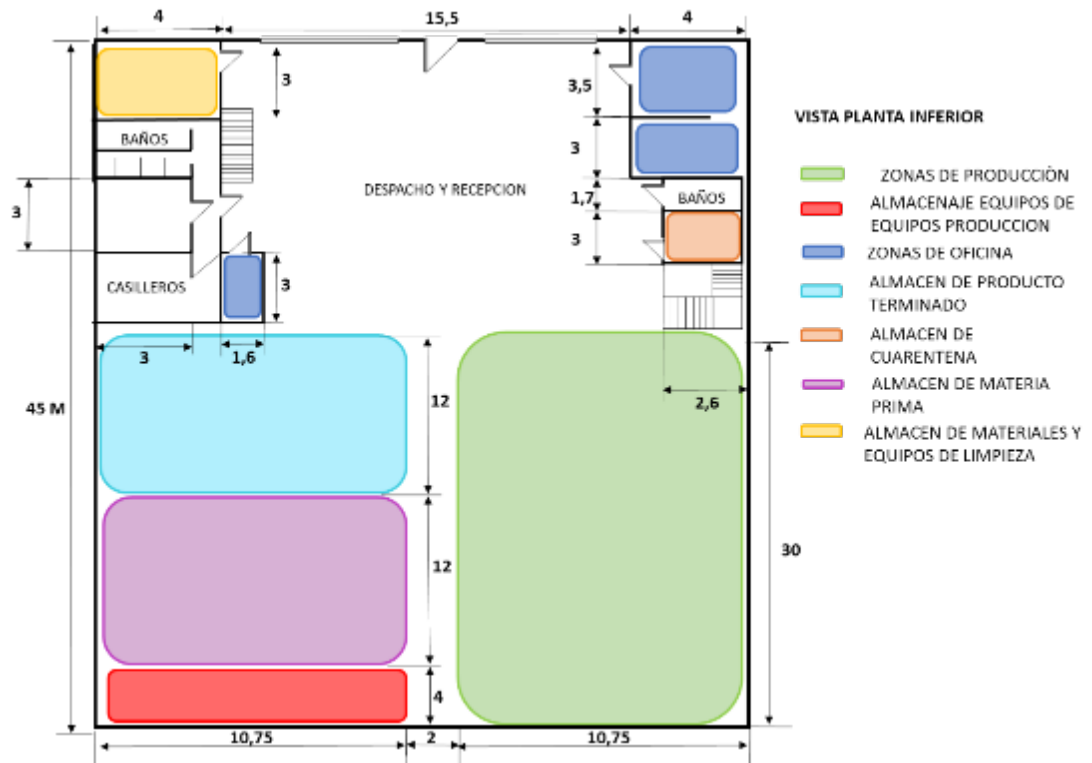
Layout propuesto de planta baja para la empresa VIA K, C.A
